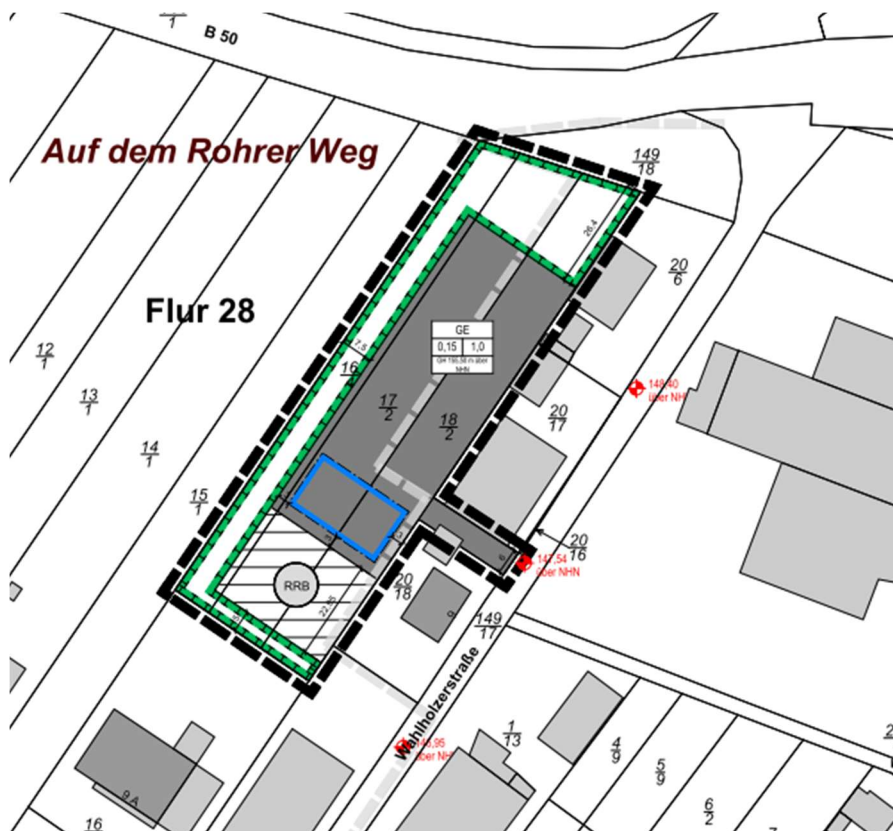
Ausschnitt Bebauungsplan, Quelle Büro Planung1
